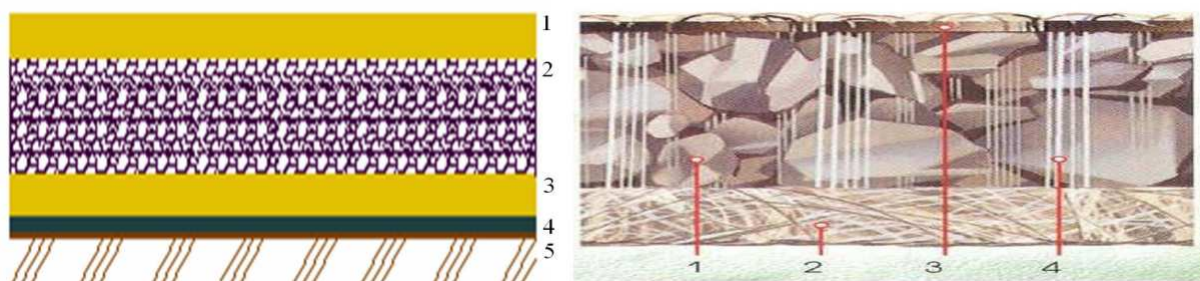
а) Поперечный профиль и б) генплан полигона
